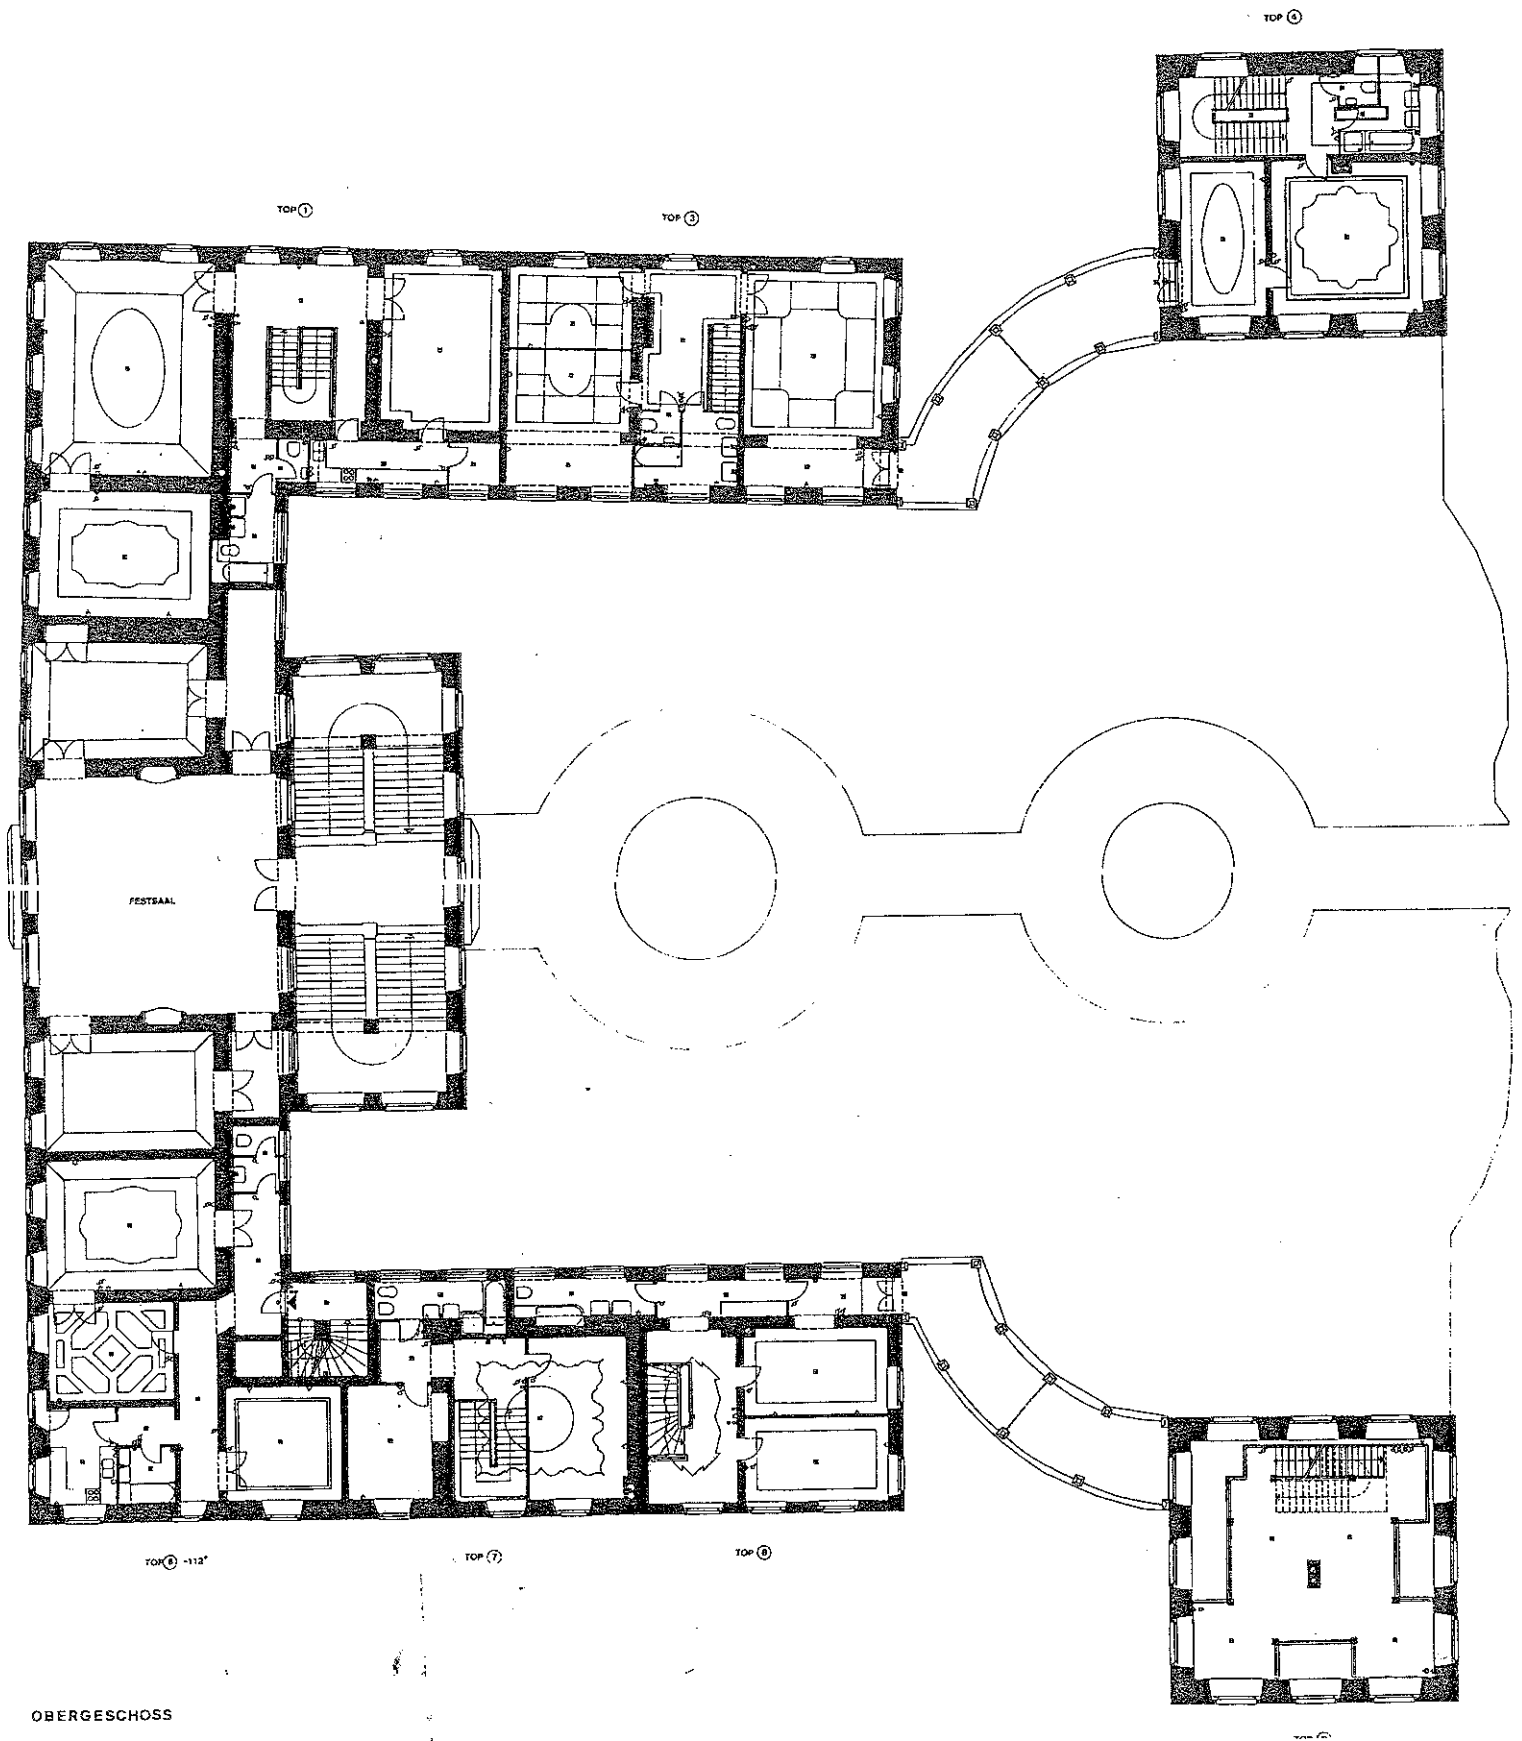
Graz, Schloss Gösting, 1724 – 1728, Grundriss Obergeschoss.
